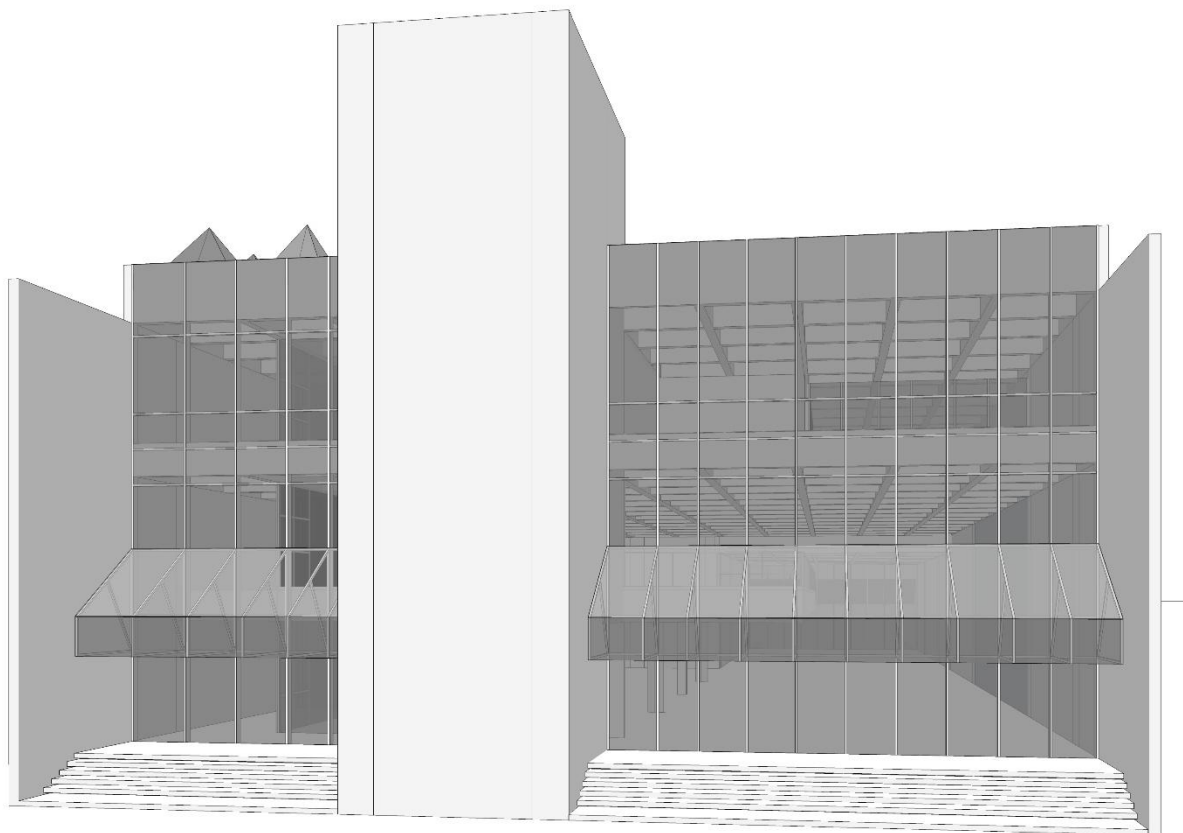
Perspectiva da fachada do Banestado vista da Av. Brasil.
